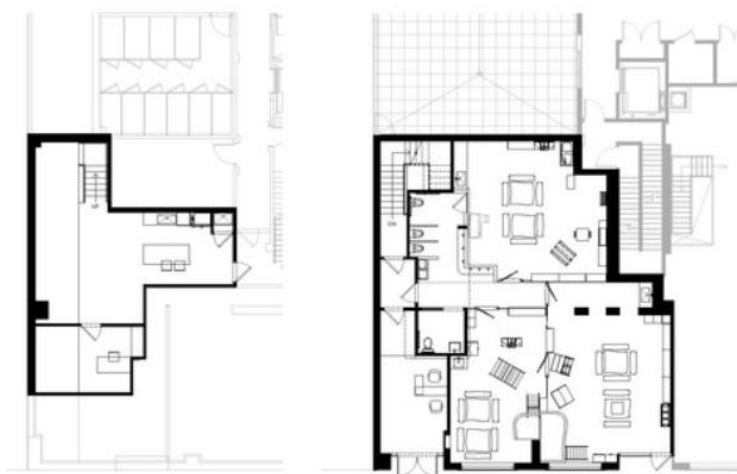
e 24 – Plantas de Mi Casita Preschool and Cultural Center
